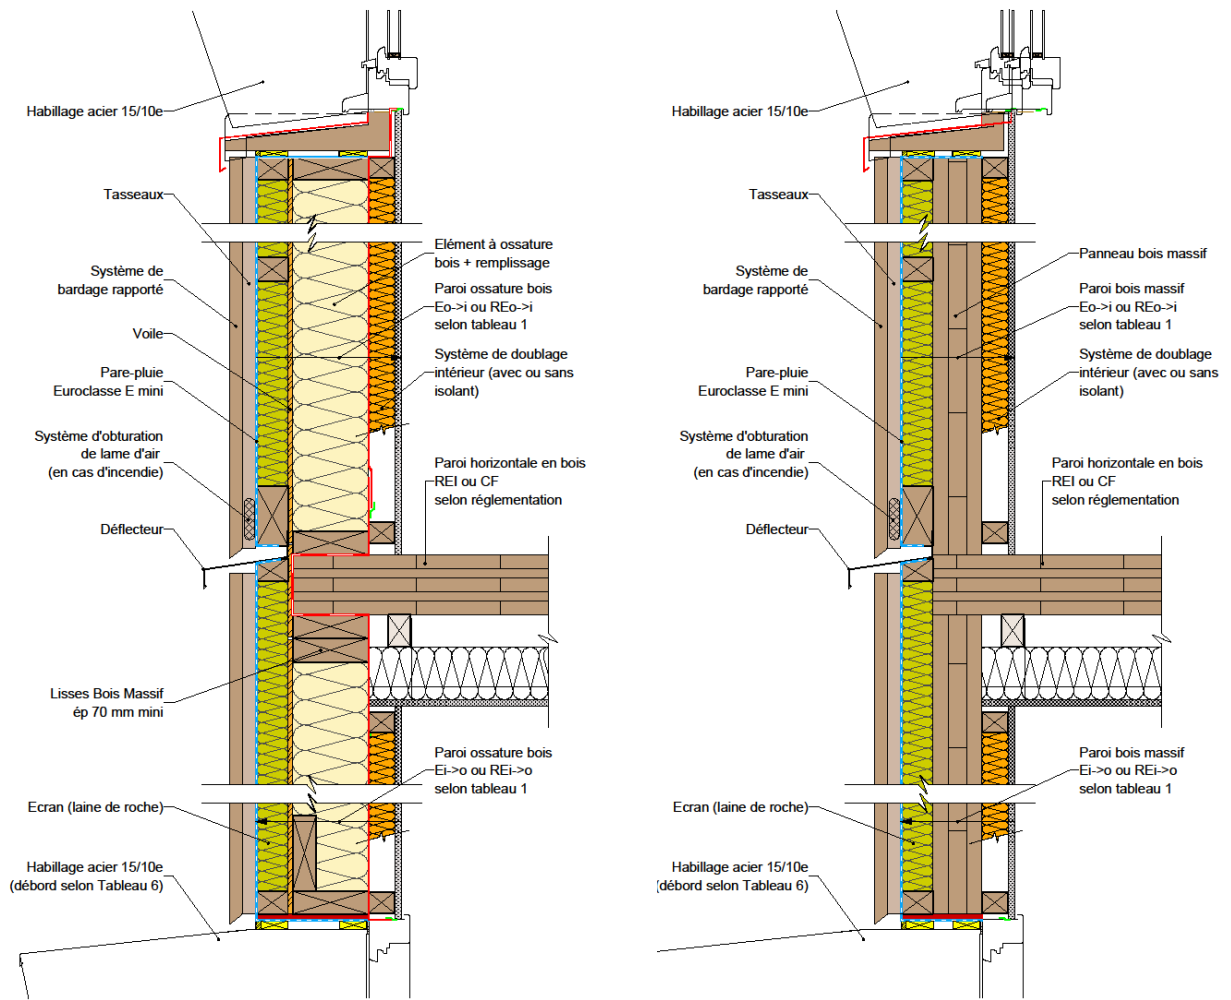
Façade/mur en ossature bois & plancher en panneaux bois massif.
